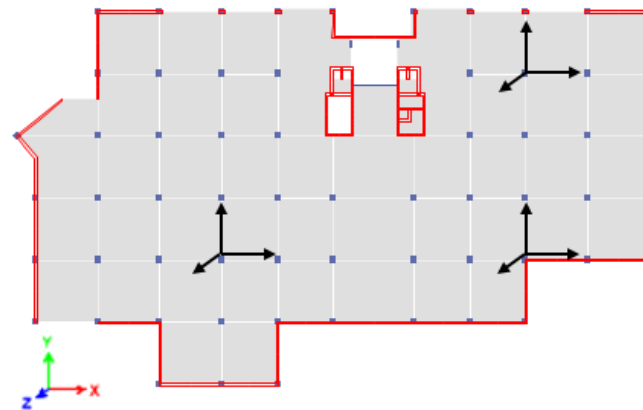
Esquema de ubicación de sensores en la Planta baja de la estructura. Instrumentación Tipo 3.
